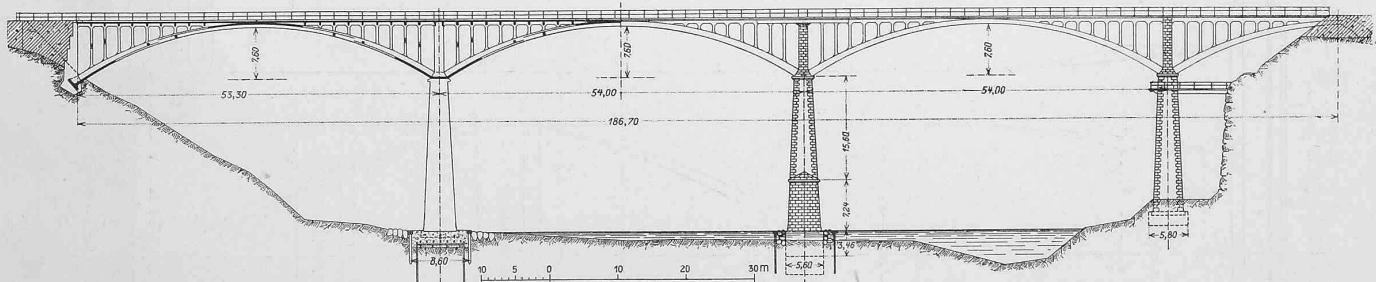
Elévation et coupe longitudinale du pont de Pymont. Echelle 1 : 1000.
